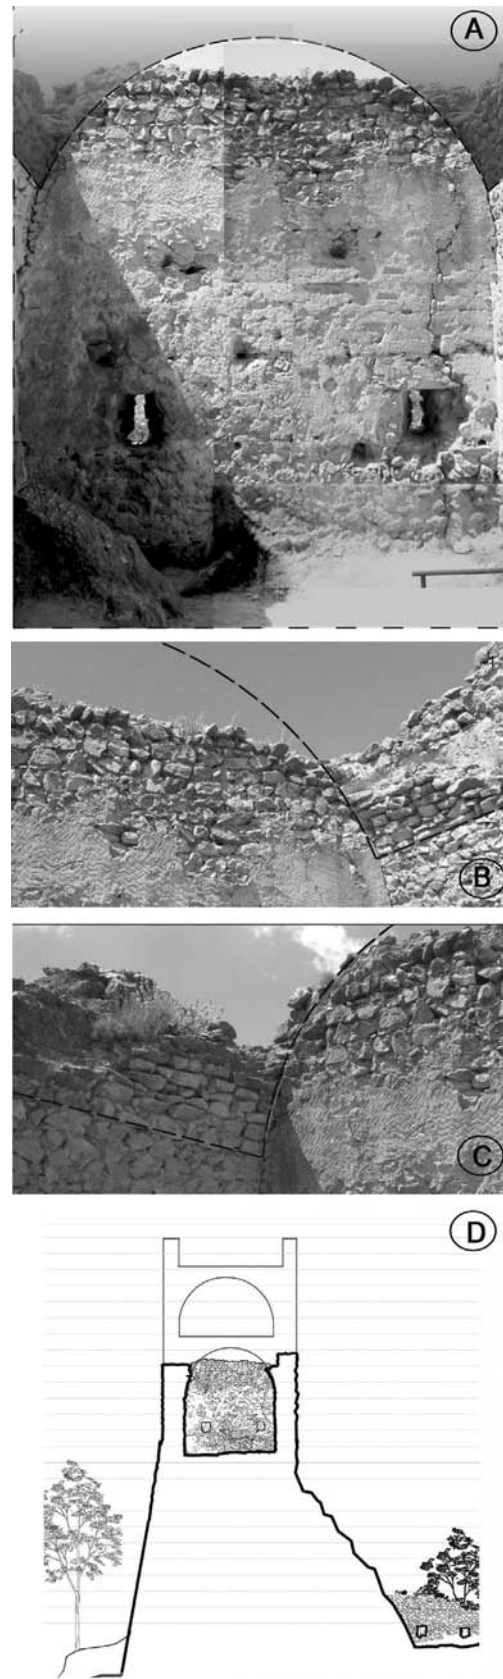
Restos de la bóveda. A: Bosquejo del trazado de la bóveda sobre montaje fotográfico de la cara interior del muro suroeste. B y C: Arranque de la bóveda en muros noreste y sureste con proyección de su posible curvatura. D: Sección con propuesta hipotética de la bóveda y del nivel superior.
